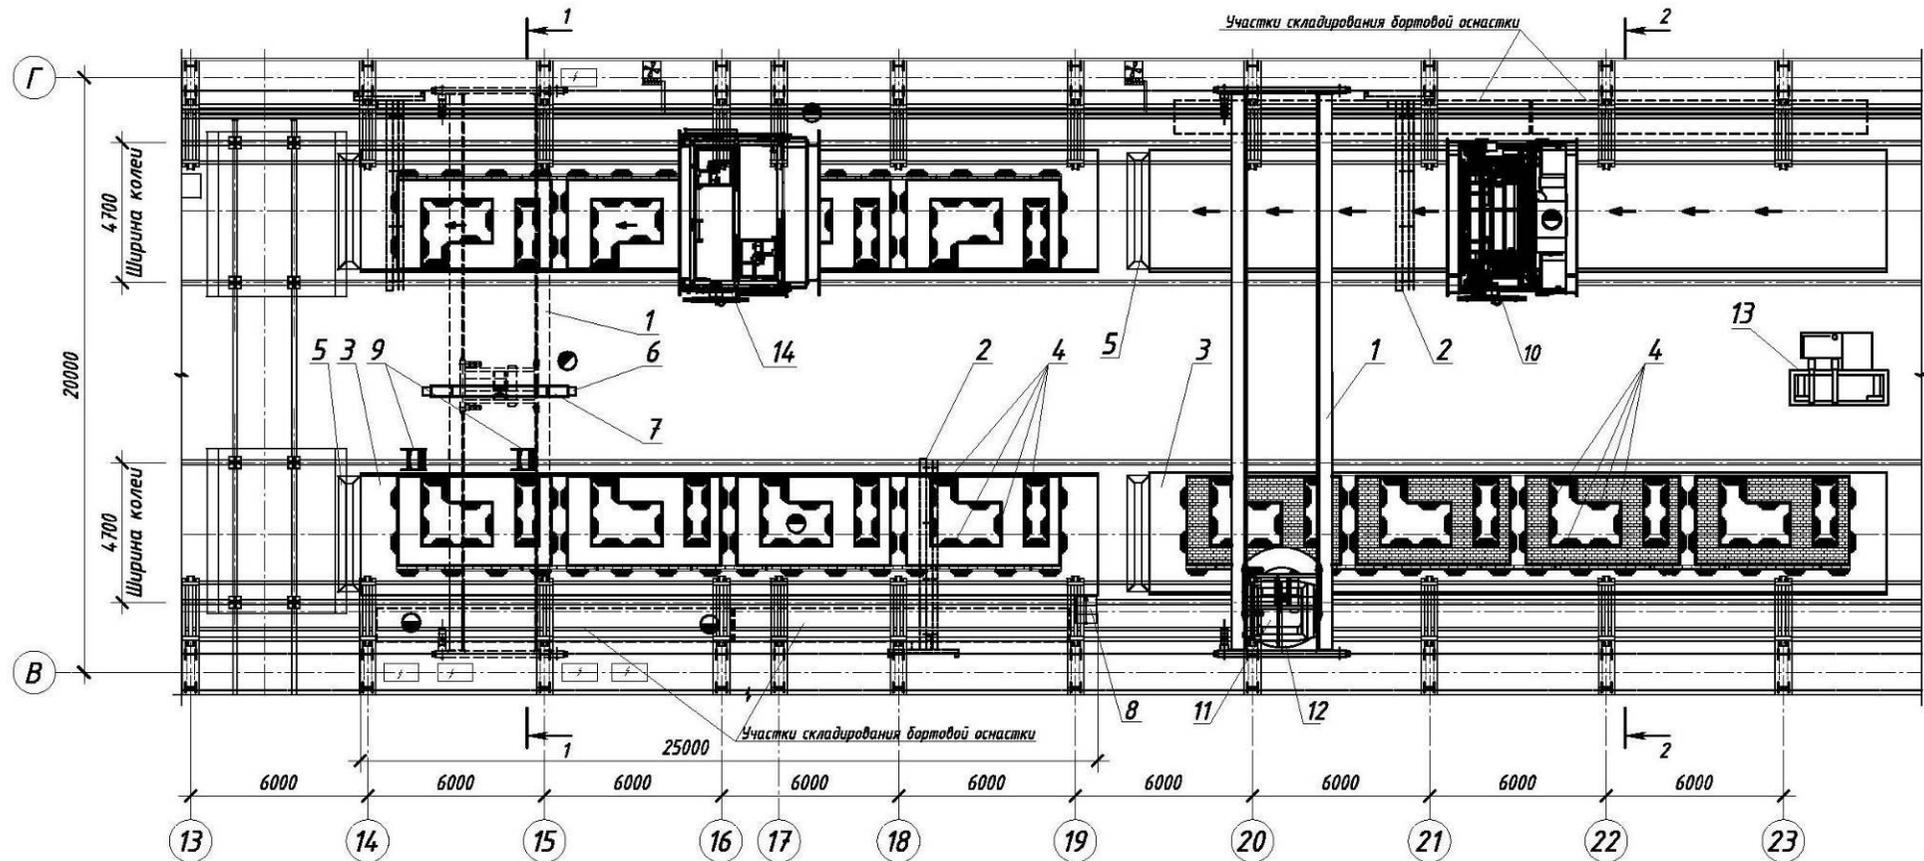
Производство железобетонных изделий на наклоняемых столах с магнитной опалубкой:
